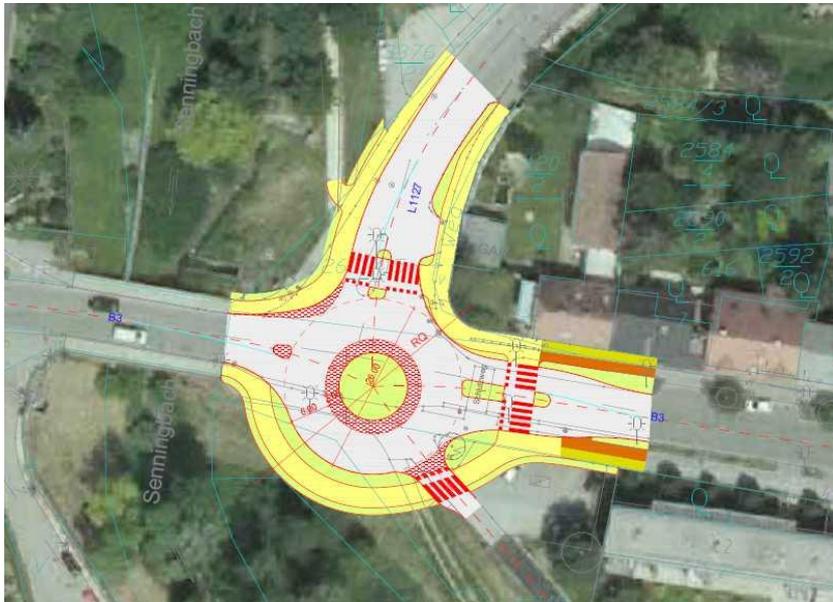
Kreuzung B3 Wiener Straße – Wiesener Straße
